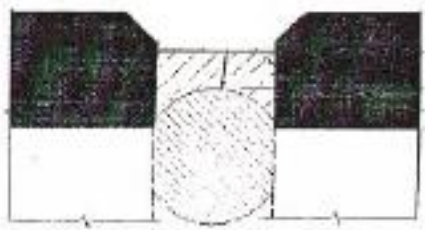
e 2. Esempi dell'Elemento Standard (Washington State Bridge Inspection Manual).
